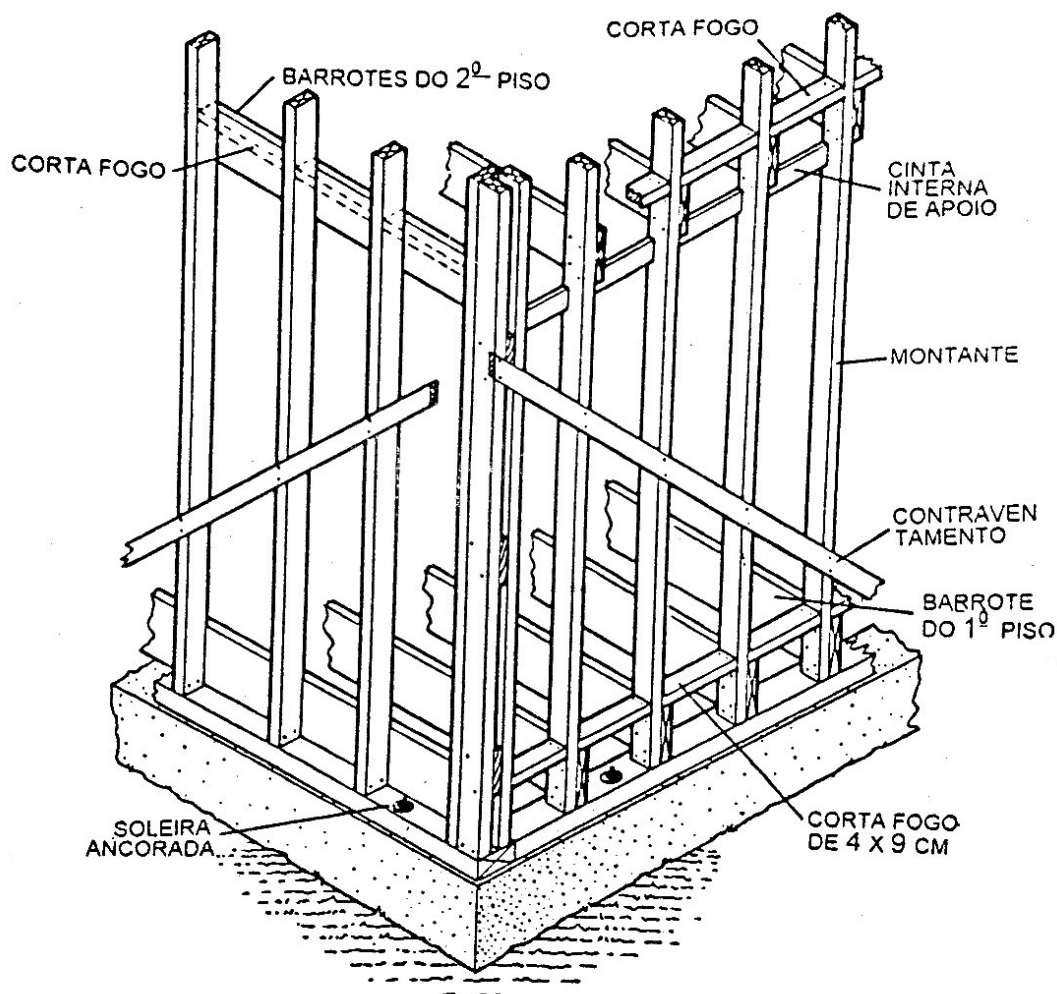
Esquema geral de uma construção no sistema “balloon frame”
